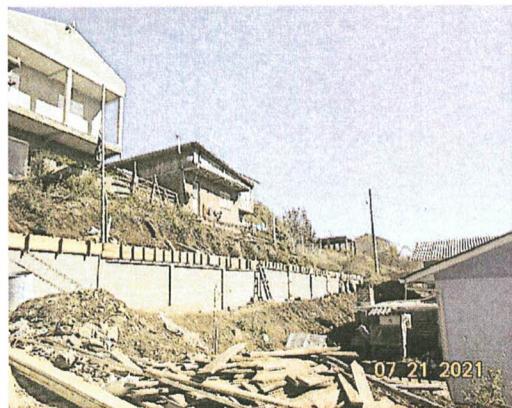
e 20 – Execução Pavimentação e Passeio Público
